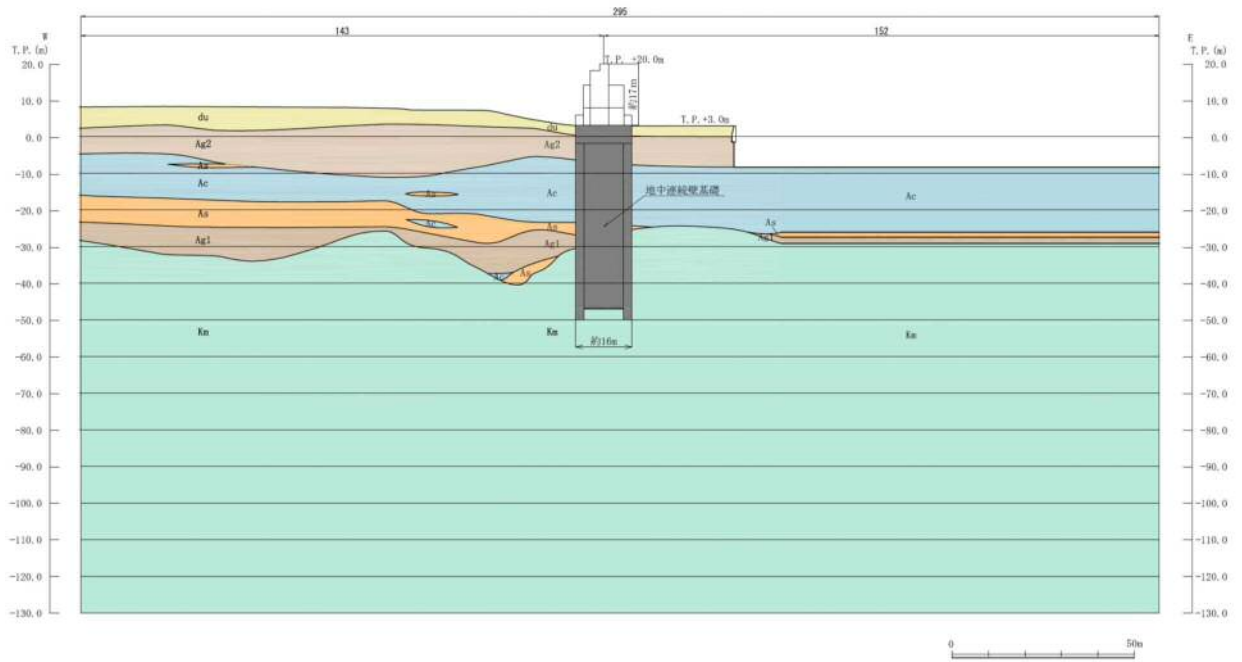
(3) 鋼製防護壁評価対象断面図 (③-③断面)
